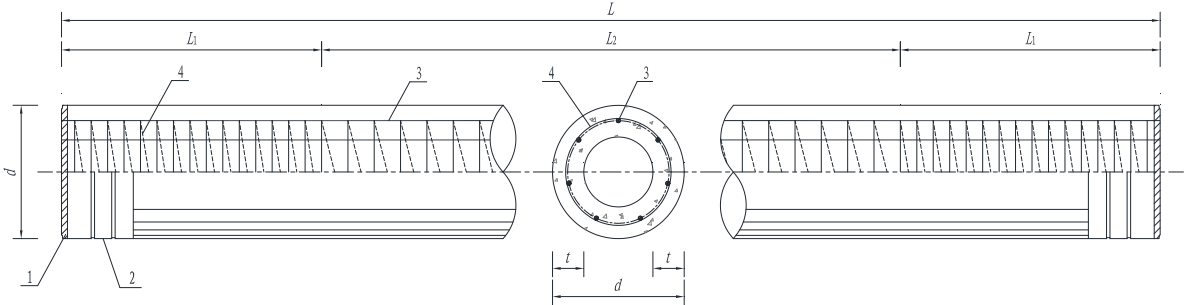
管桩（预应力混凝土管桩、预应力高强混凝土管桩、预应力超高强混凝土管桩、薄壁混凝土管桩）结构形式示意图
